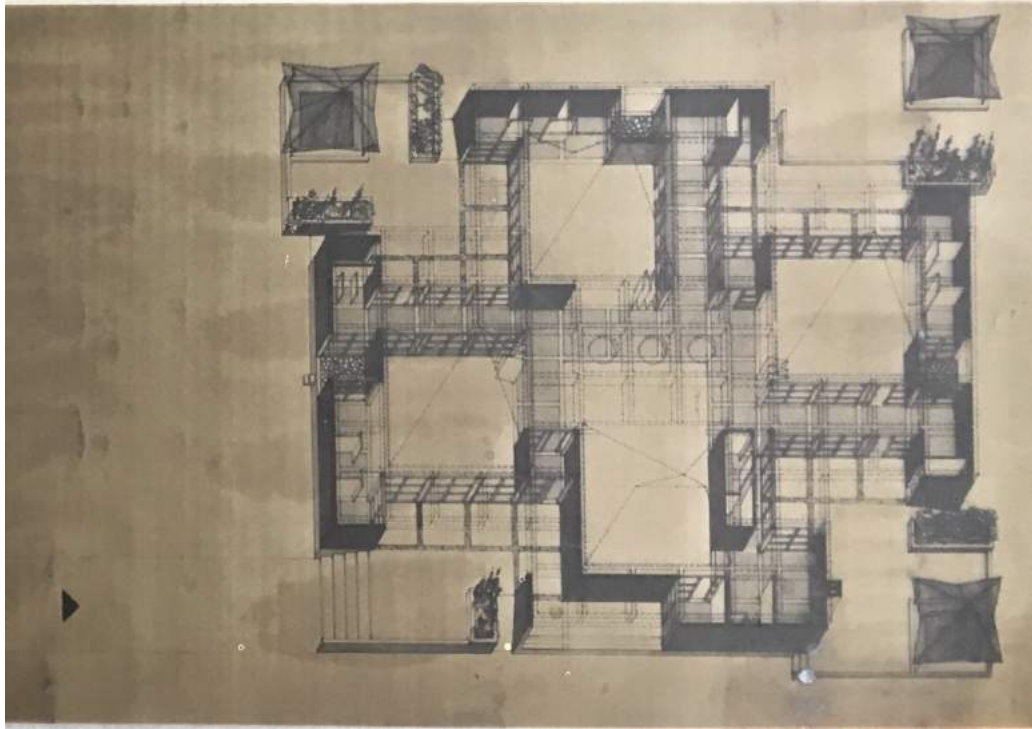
Grundrisschema Kindergarten Eggersdorf, 1971
